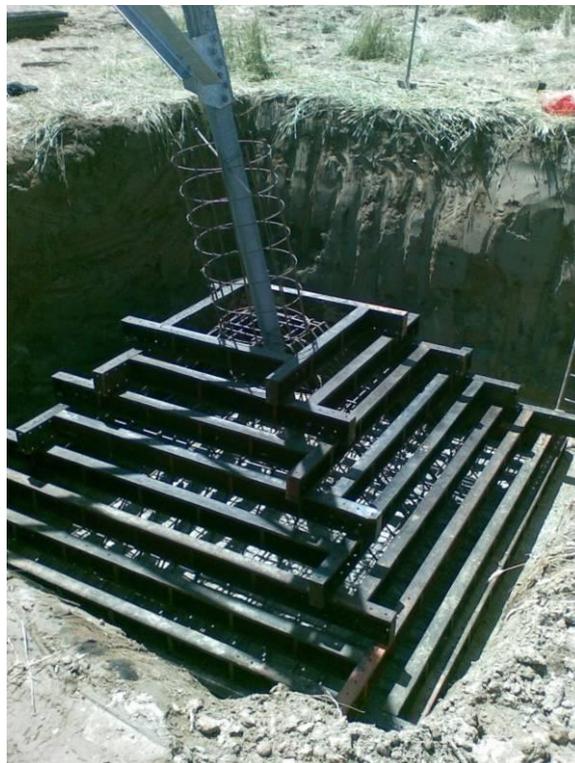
Esempio di realizzazione del piede di fondazione
